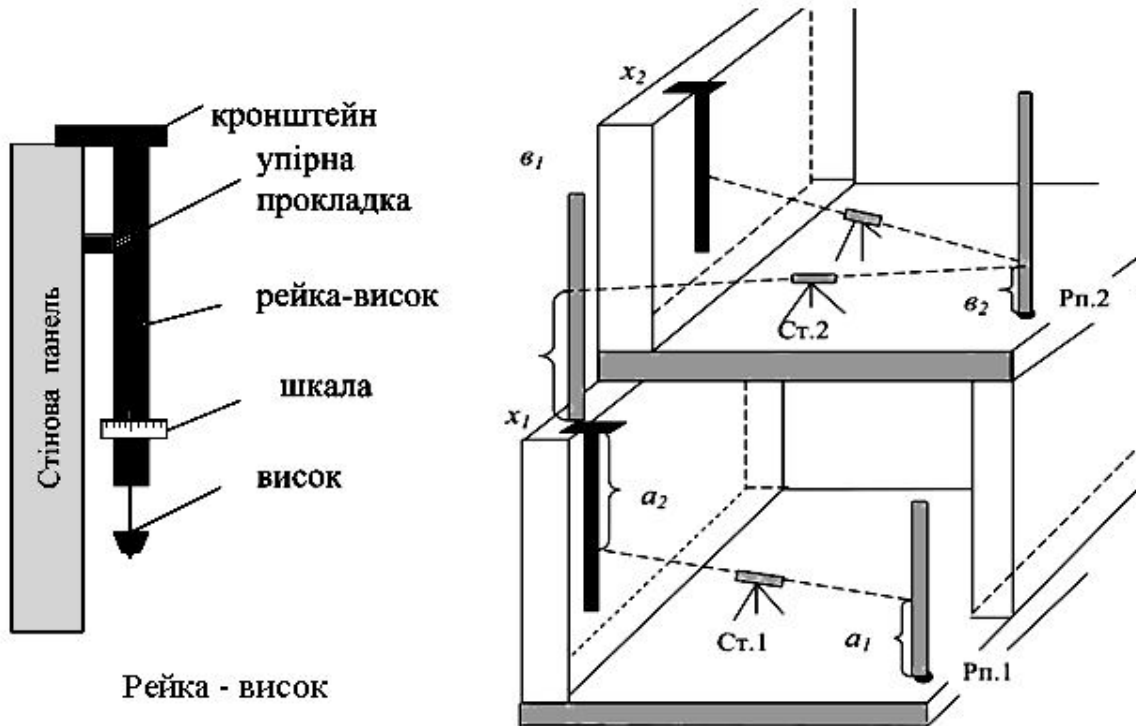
Схема передачі висот з поверху на поверх
